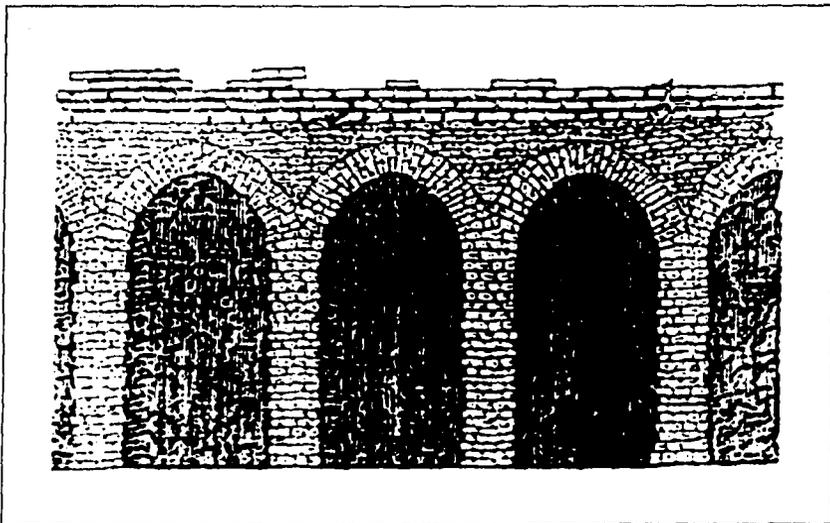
Construcciones aligeradas en el siglo XVI ⁽¹⁾
